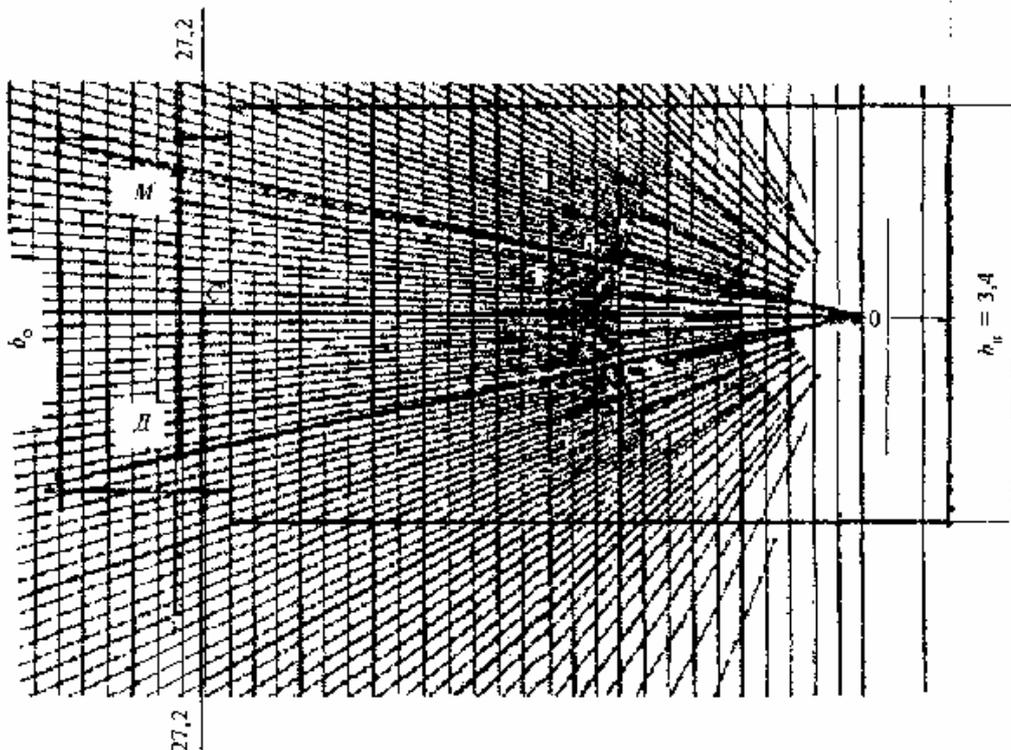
Совмещение графиков I и II с поперечным разрезом и планом жилого помещения
